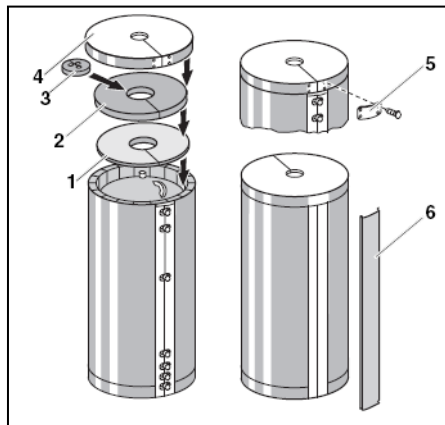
Монтаж теплоизоляции (принципиальная схема)
